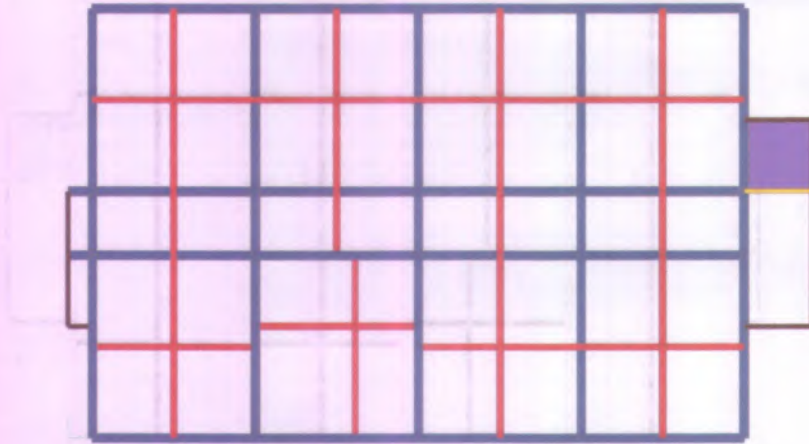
Denah posisi pembebanan gempa lantai 4 [+11.00].
